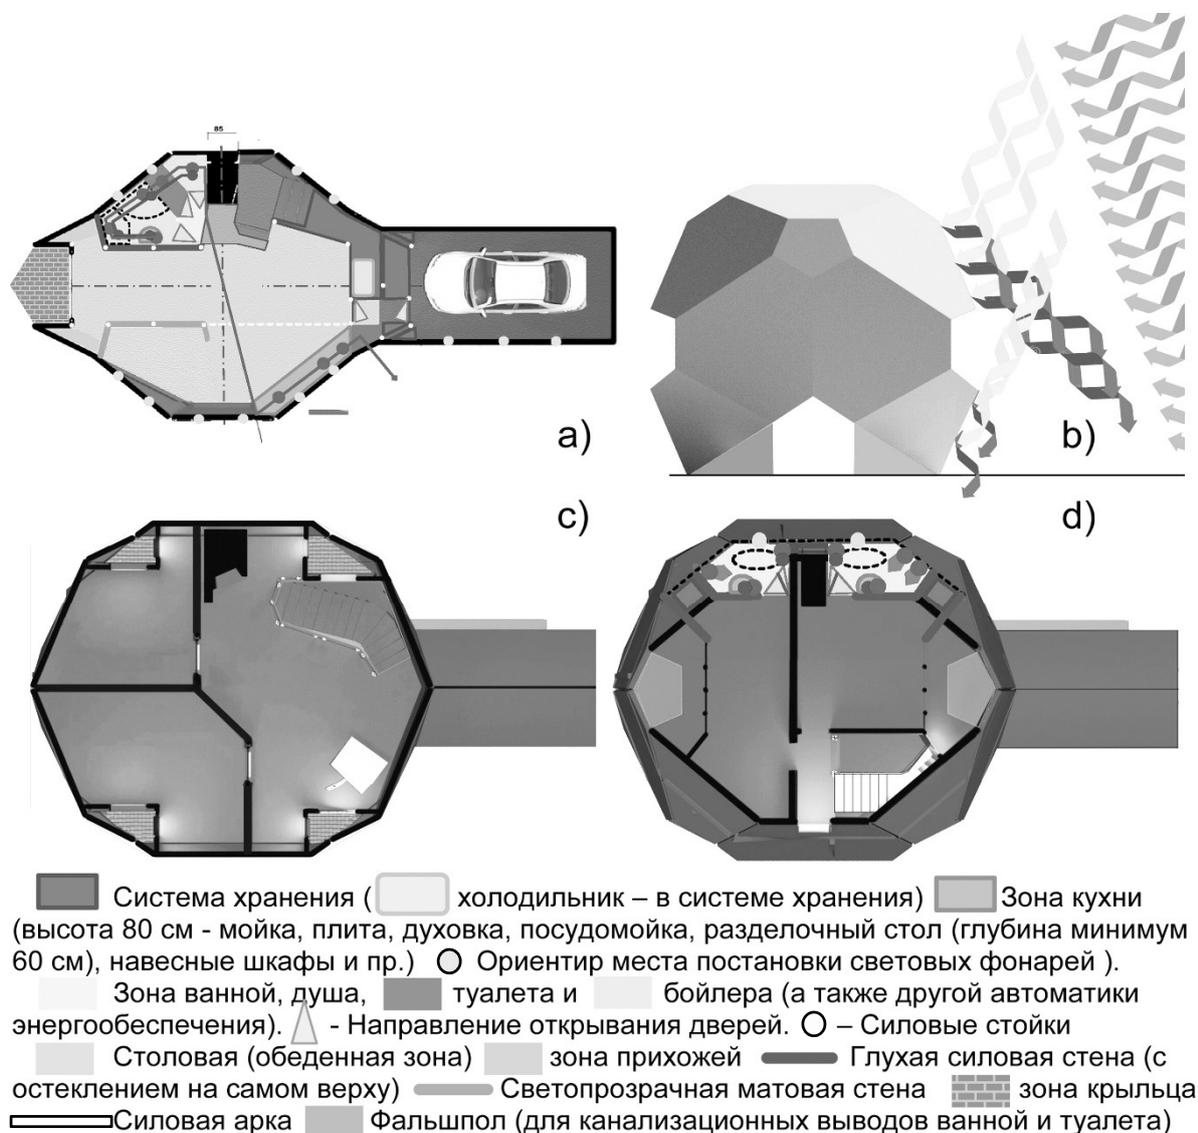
Поэтажная планировка: а) 1-й этаж (длина метки - 1м); б) «геометрическая солнцезащита» стен и световых проемов; с) 2-й этаж – каминный зал; d) мансарда с навесами крыши над балконами.
